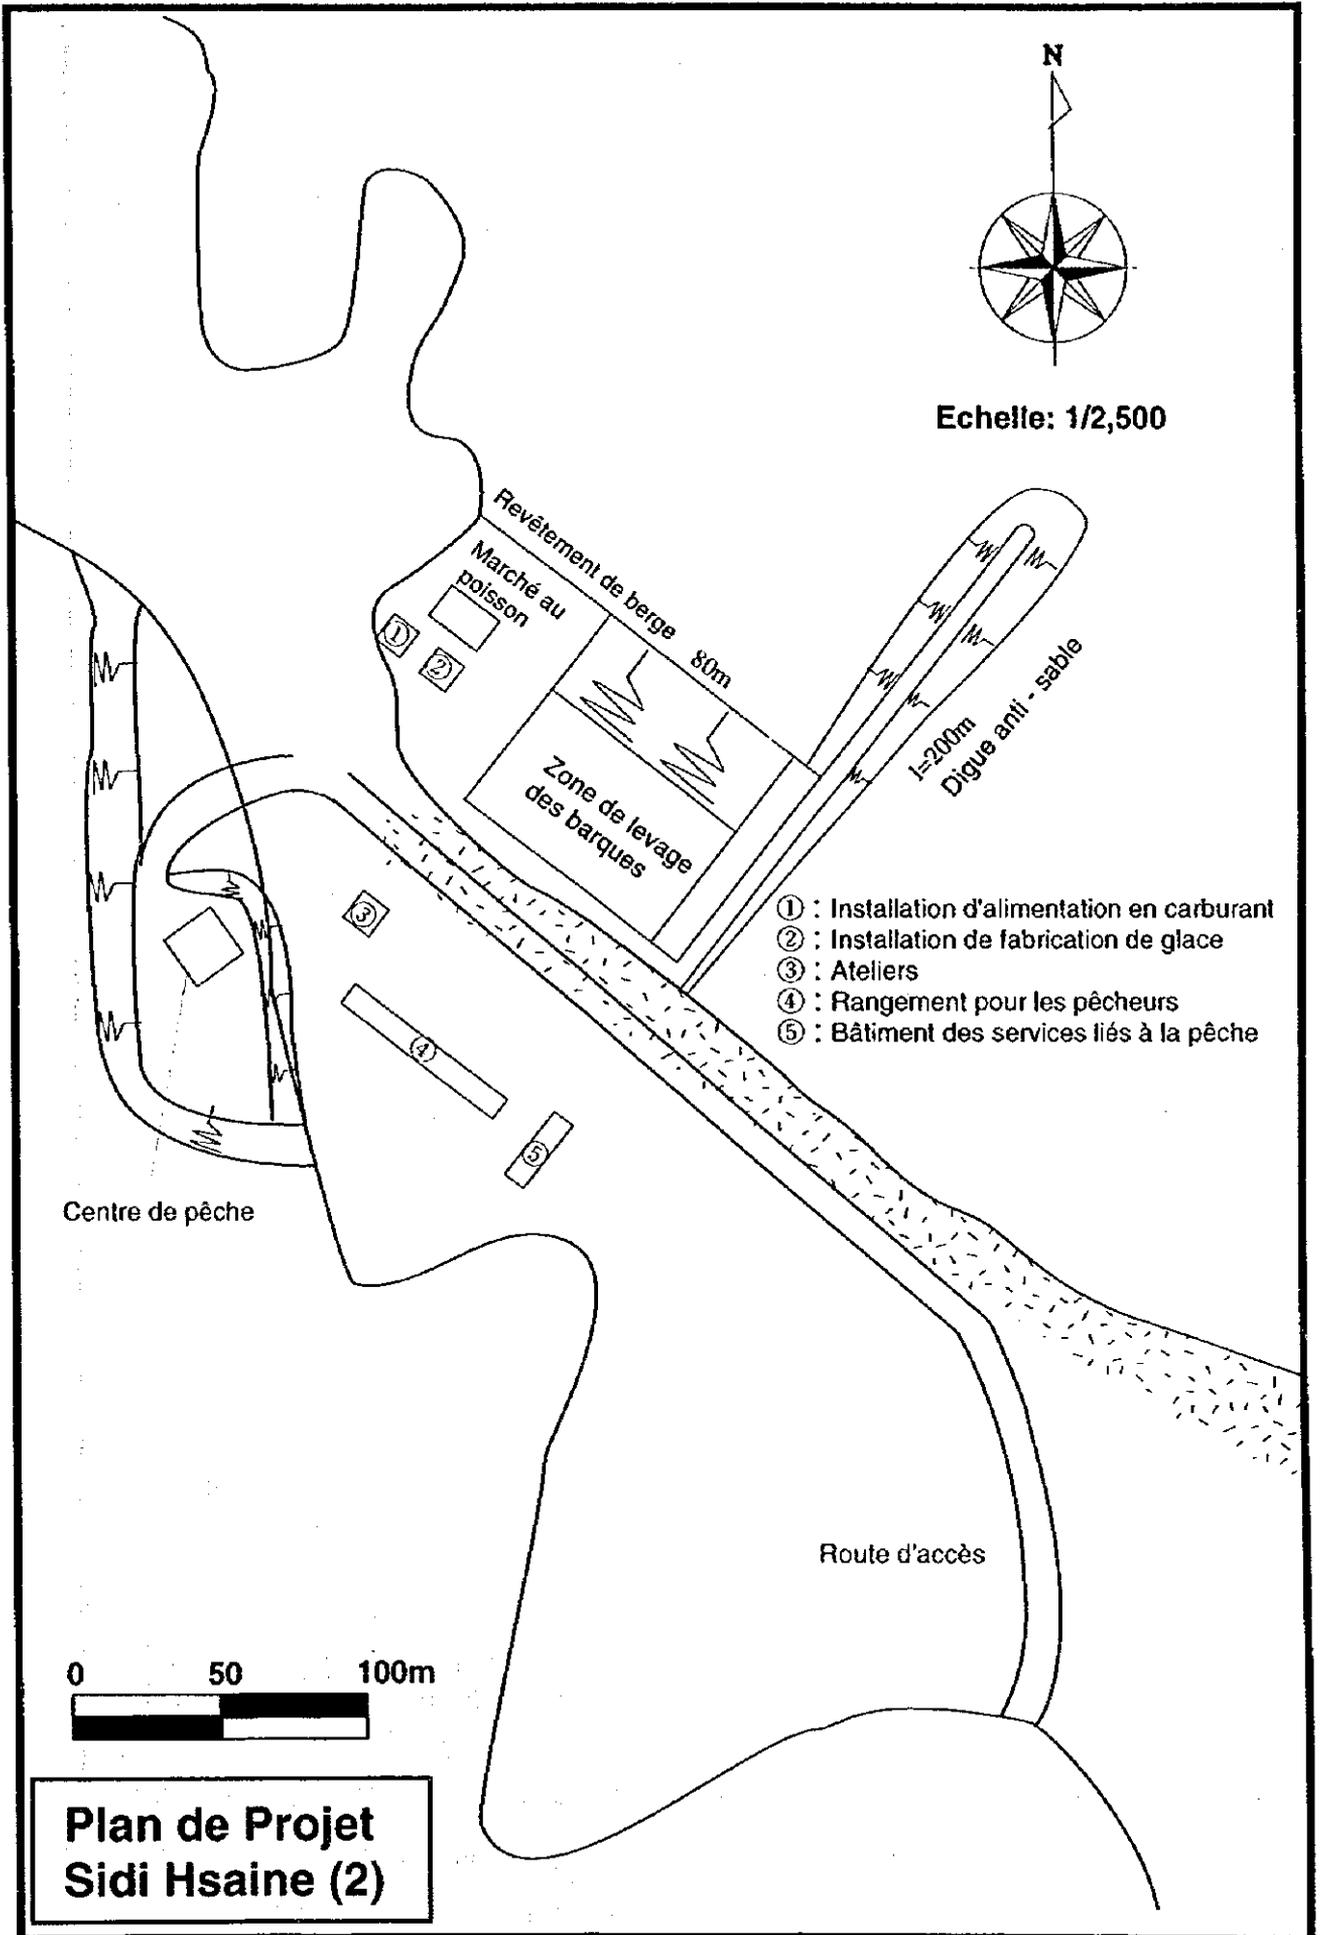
B-7 Projet de disposition des installations à Sidi Hsaine (proposition 2)
